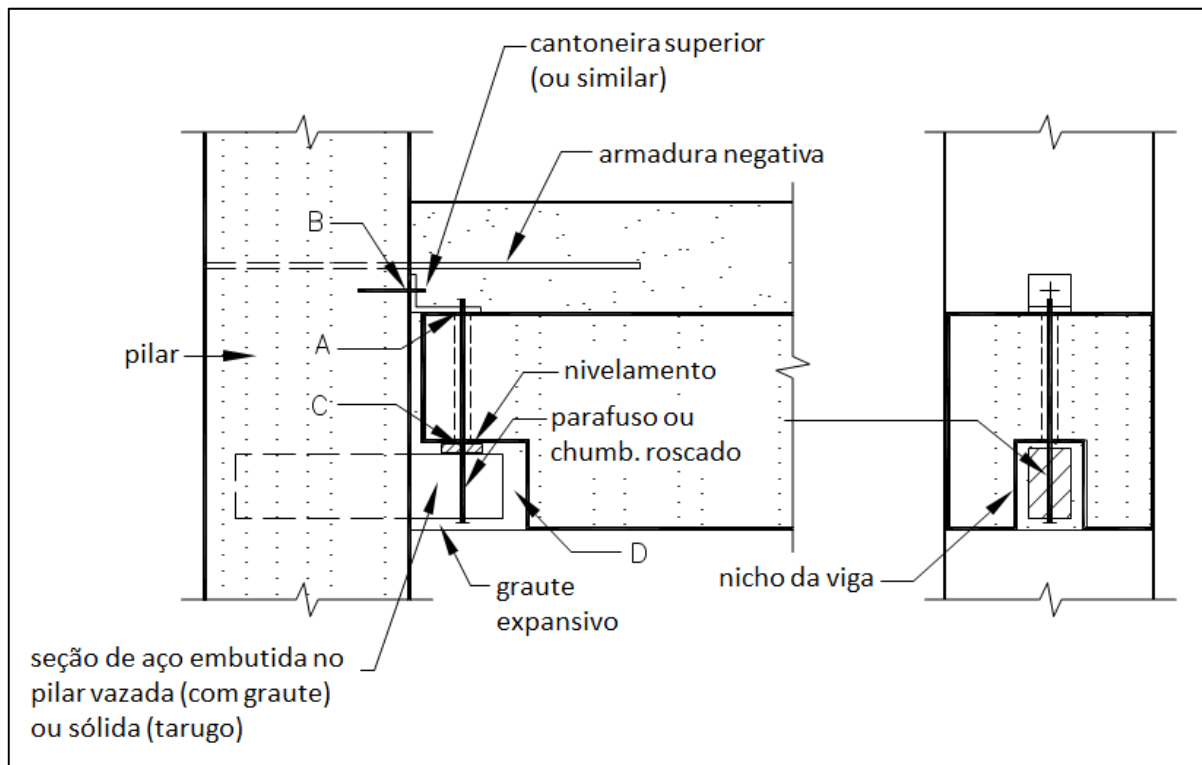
Princípio de projeto para o inserto do pilar (estribos concentrados).
